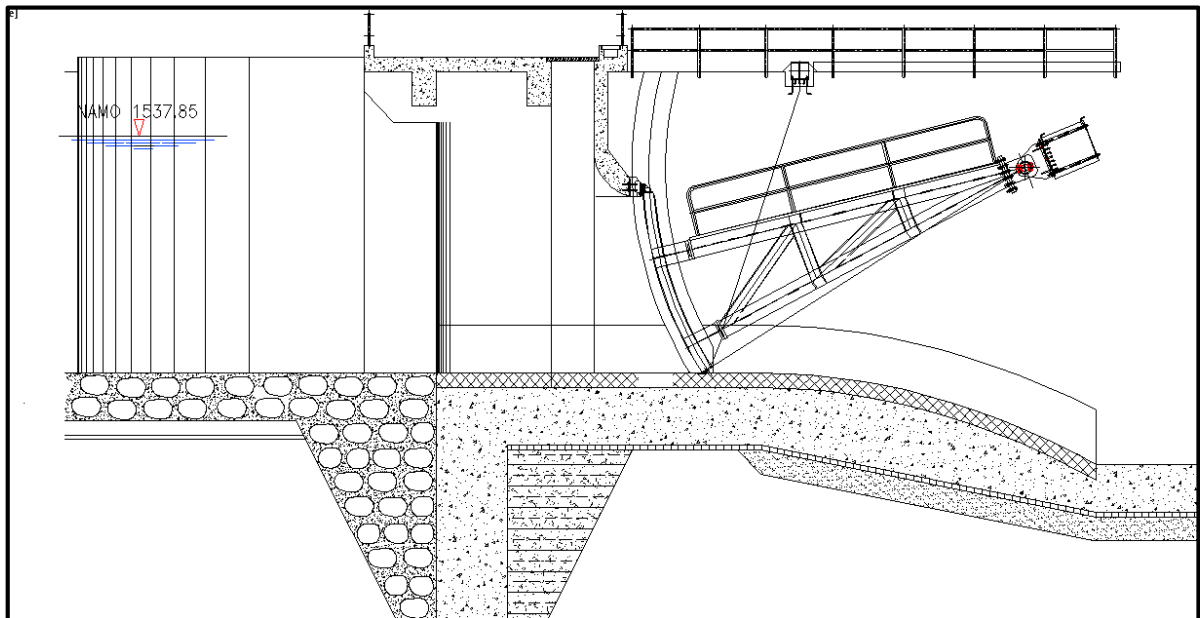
Vista de perfil de una compuerta del barraje móvil.
